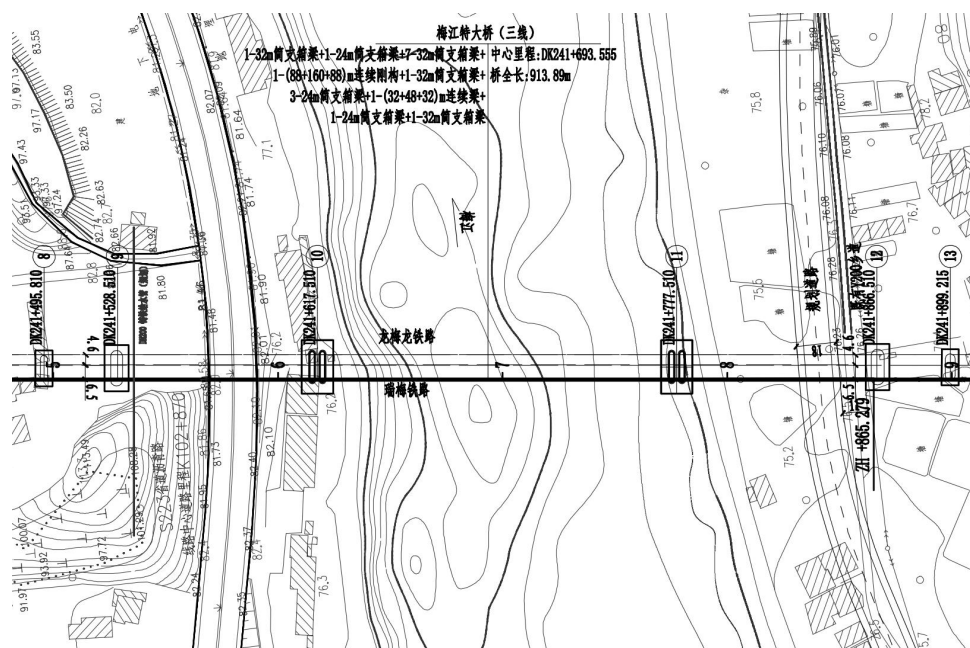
梅江特大桥主跨 160m 连续刚构跨越梅江平面布置图
